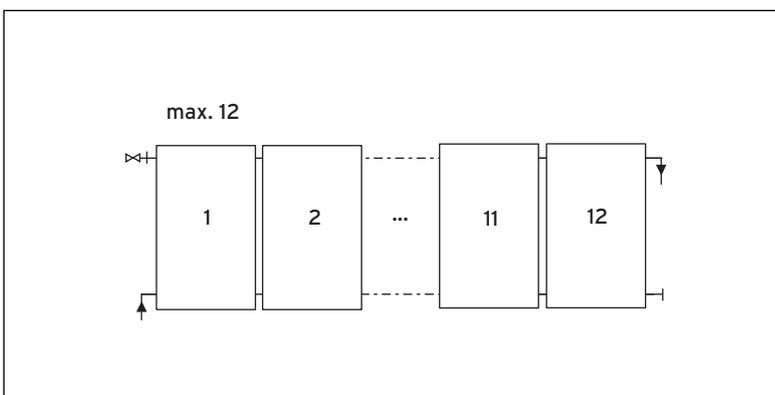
Conexión en línea, colectores planos 6 - 12
